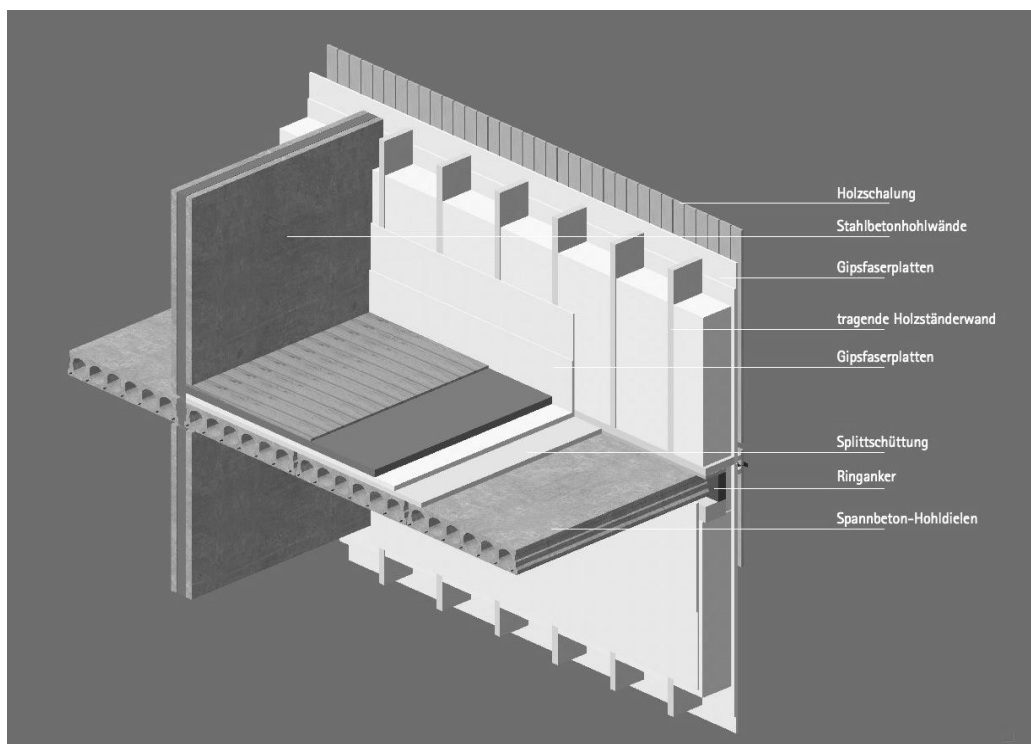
Bauteile des Holz-Beton-Hybrid-Bausystems
